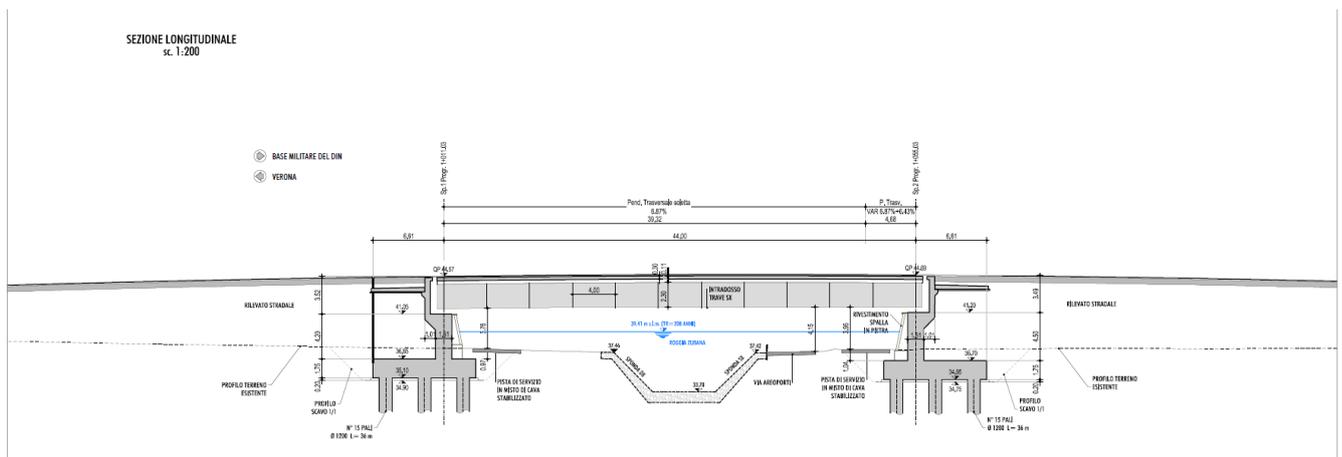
SEZIONE LONGITUDINALE DEL PONTE
